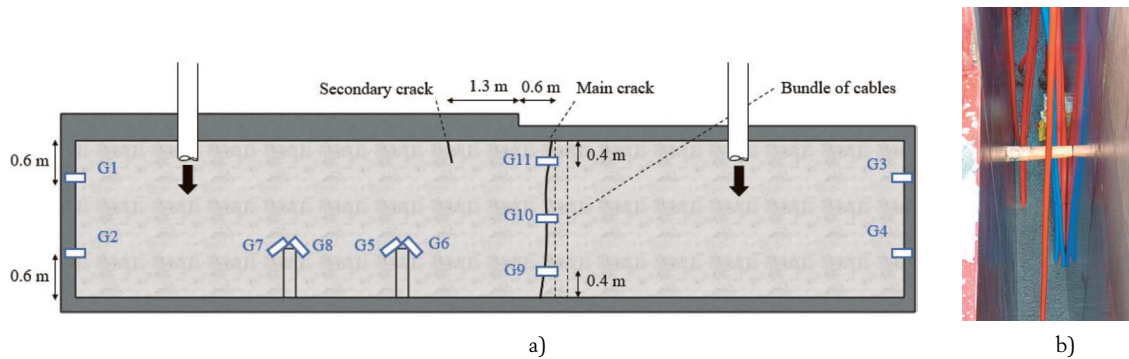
(a) Geometría, procedimiento de vertido, testigos de monitorización de fisuras y ubicación de las fisuras para el muro de MSFRC más largo del edificio real; (b) fotografía del haz de cables dentro del encofrado durante el vertido del hormigón.
